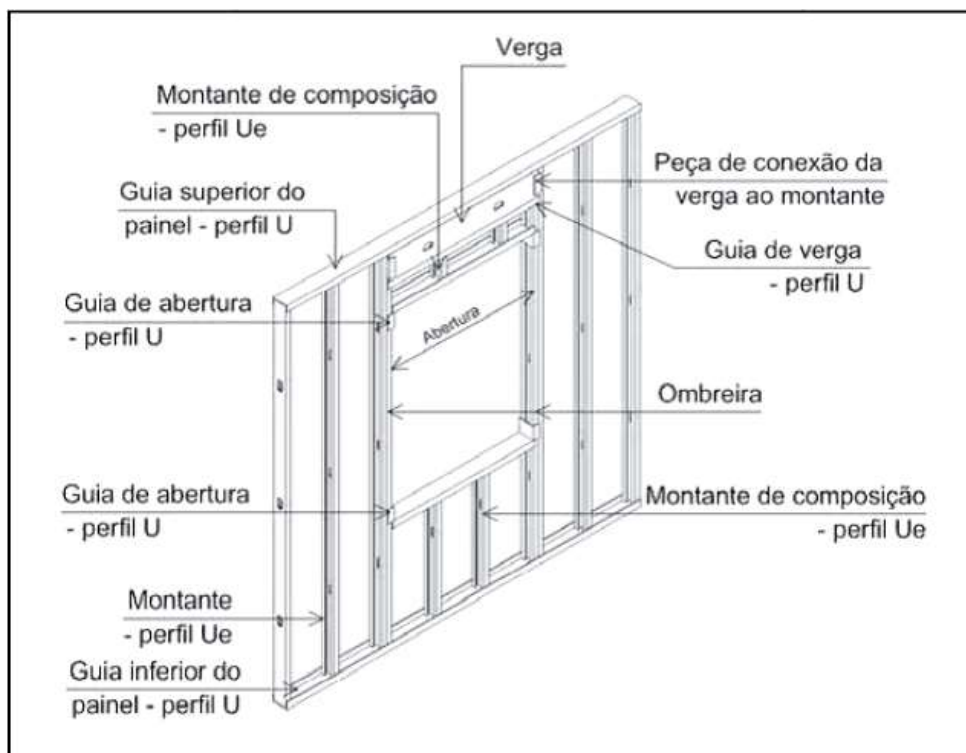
Desenho esquemático de painel estrutural com cobertura
